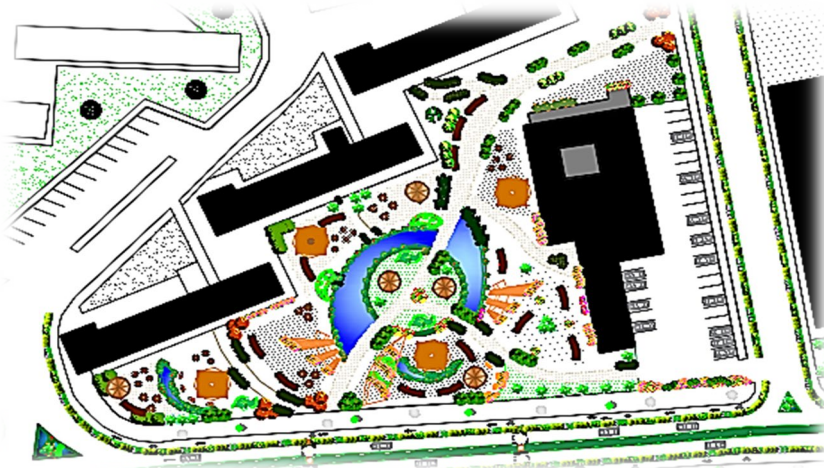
Vue en plan sur le jardin de l'hôtel source : auteurs
